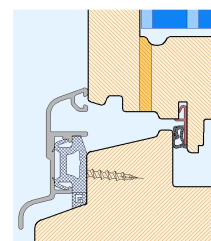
neue Profilierung mit günstigen Abstand Dampfdruckausgleich zur Mitteldichtung
